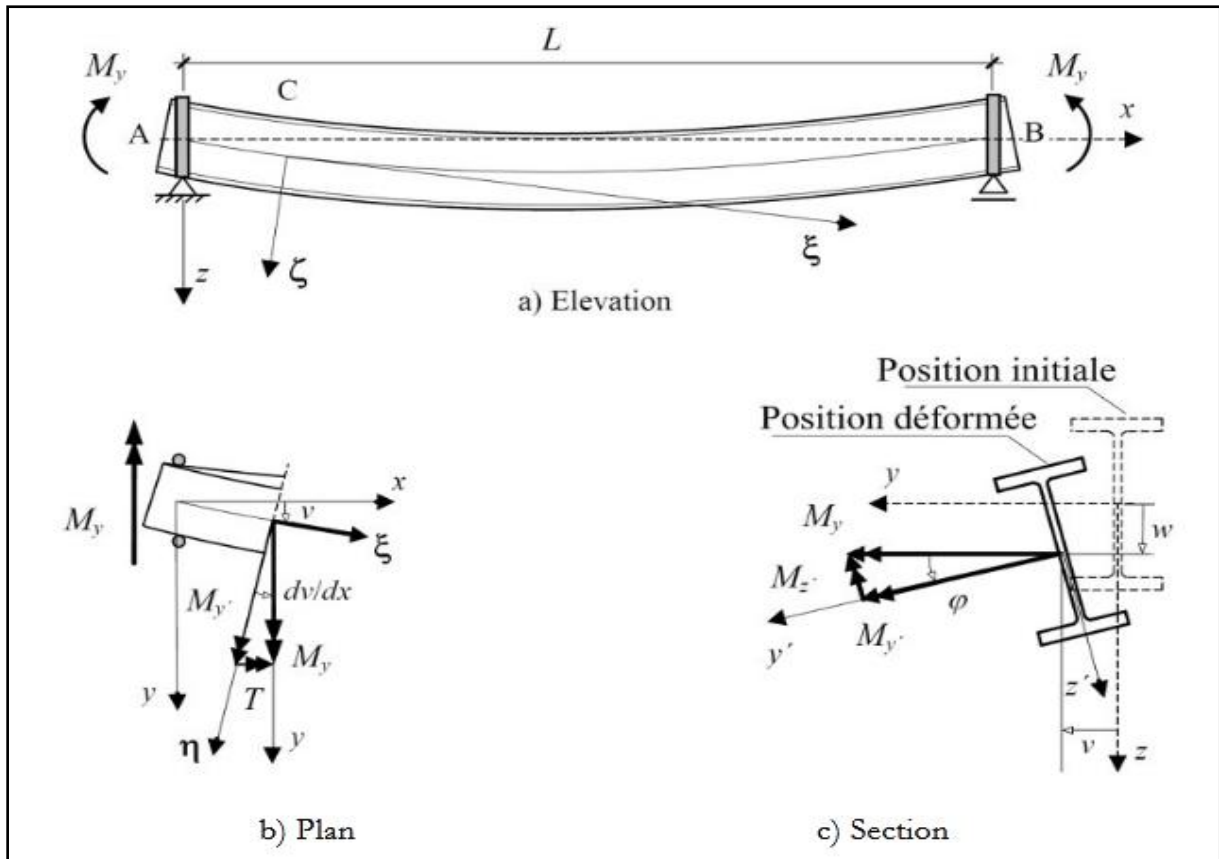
Déversement d'une poutre constituée d'une section en I bi-symétrique, sollicitée en flexion pure.
